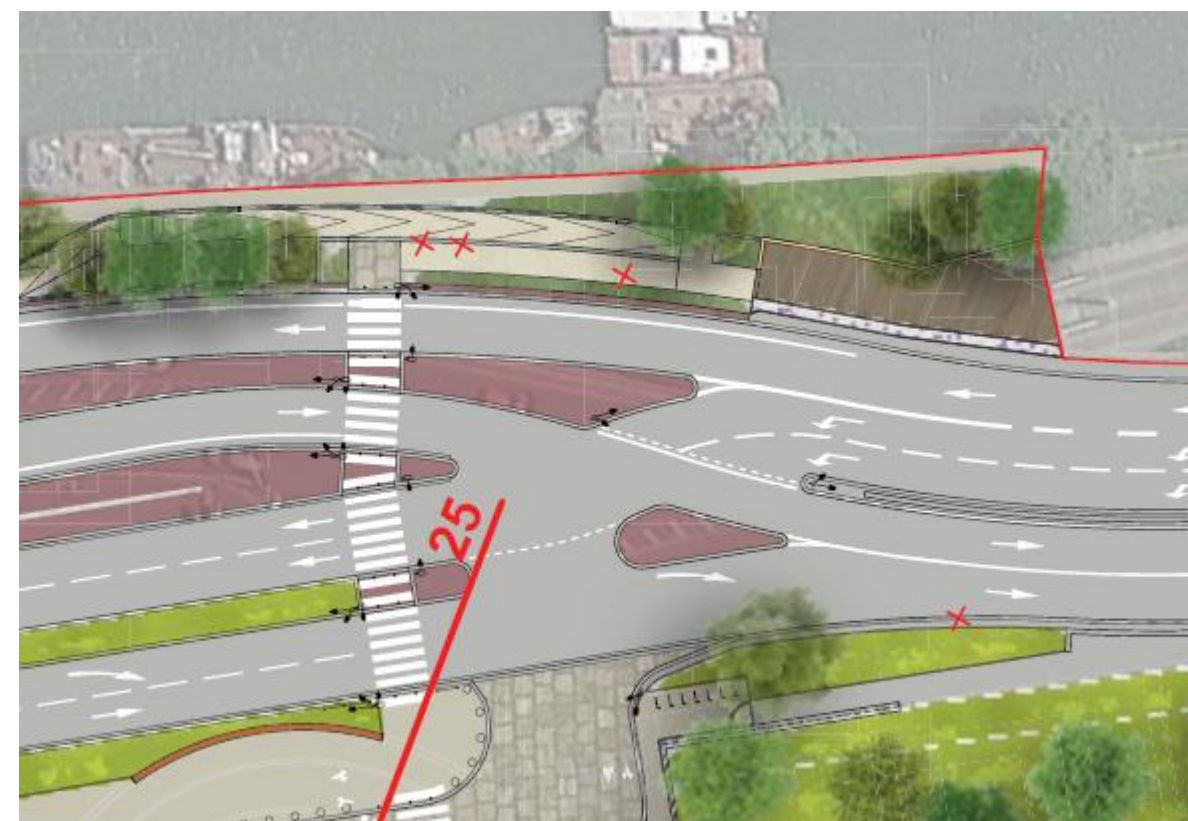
Plan projeté du carrefour RD7x Avenue de la Grille d'Honneur
